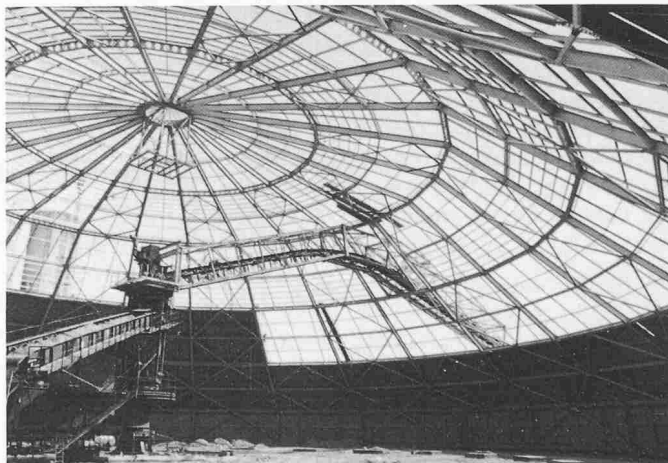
Mischbett-Halle. Einführung der Bandbrücke
